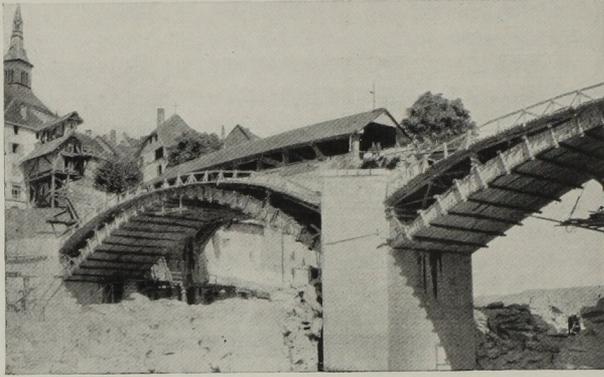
Lehrgerüst der Rheinbrücke Laufenburg
